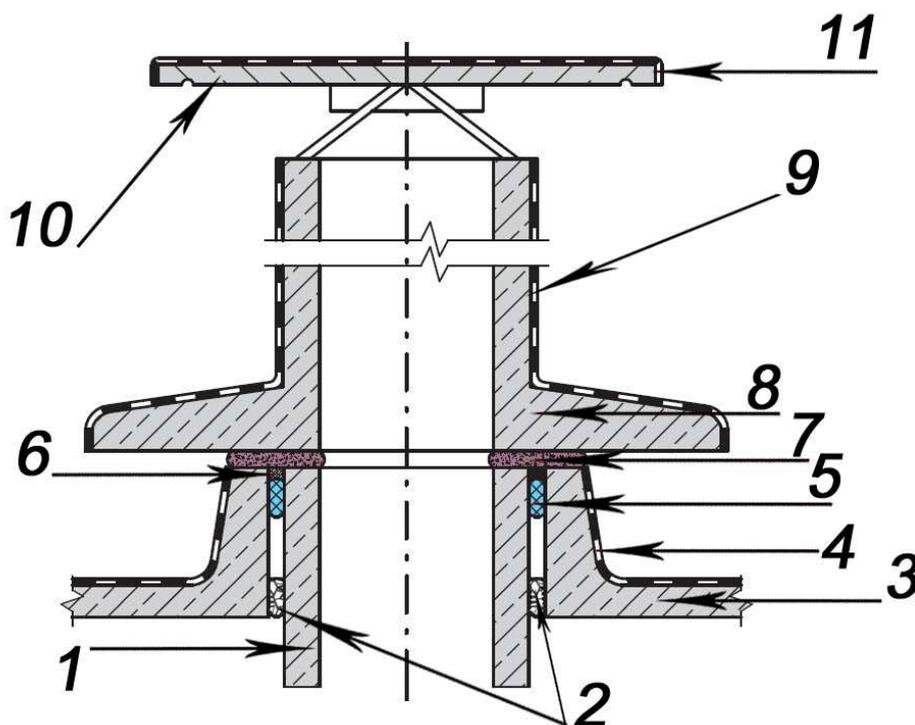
Ремонт примыкания кровельной панели и вентиляционного блока
